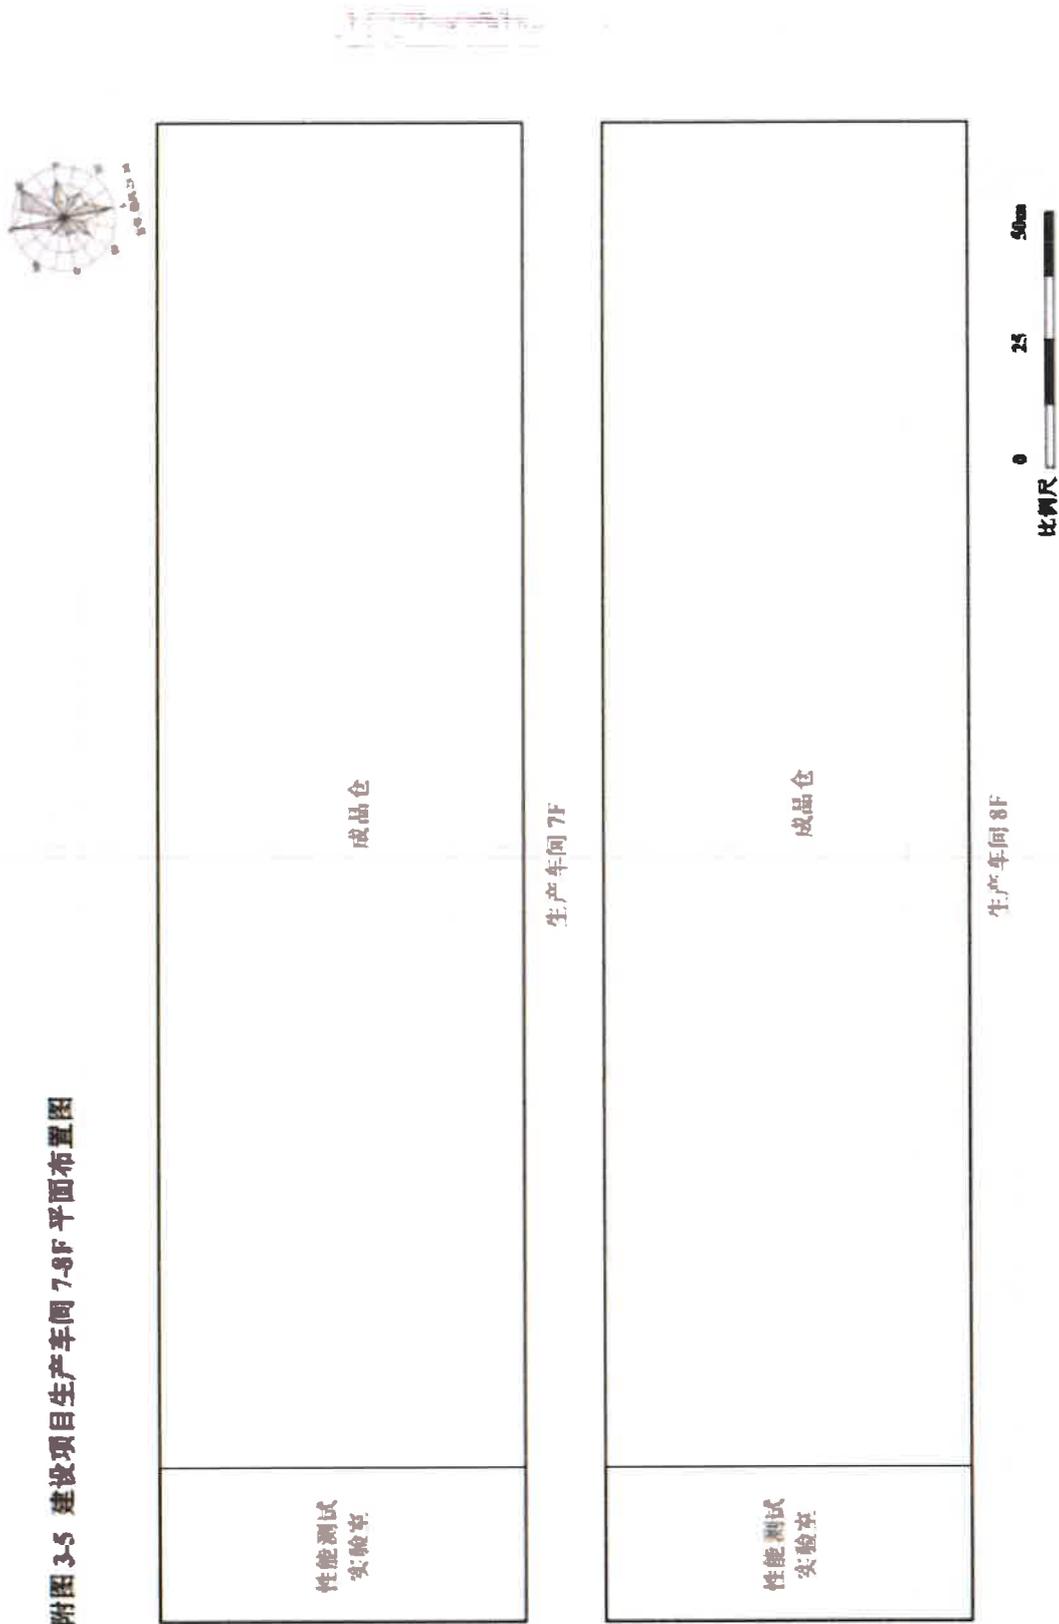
1 号厂房生产车间 7-8 层的平面布置图
